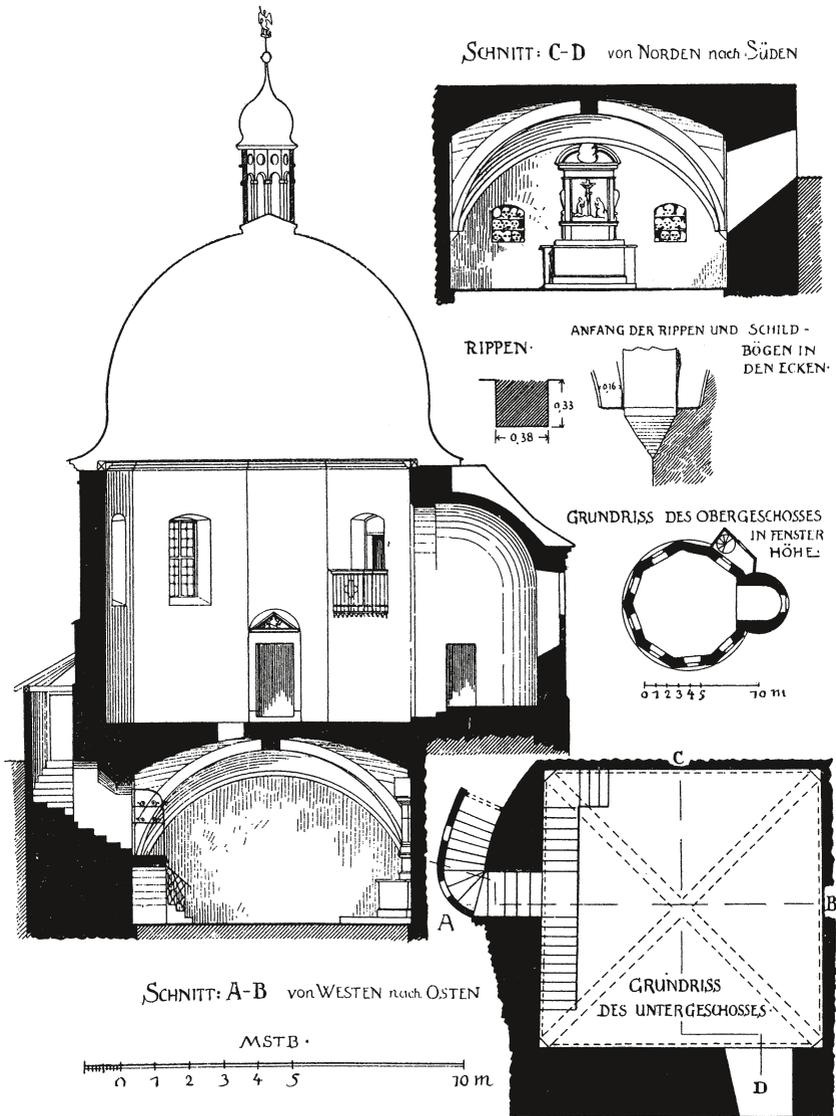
Laufen, Lkr. Berchtesgadener Land. Grundrisse und Aufriss (nach Bezold/Riehl/Hager 1905a, 2760).
